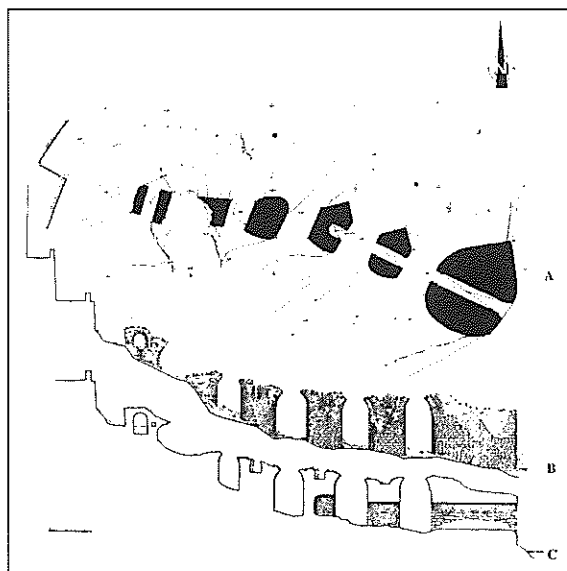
Torre do Rio. A. Planta; B. Alçado Montante; C. Corte
